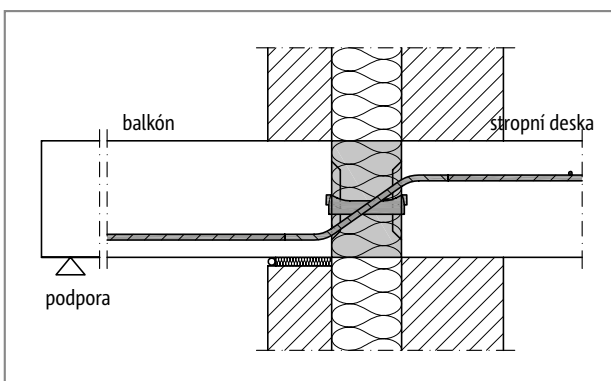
Schöck Isokorb® typ QXT: Balkón se sloupovými podporami
